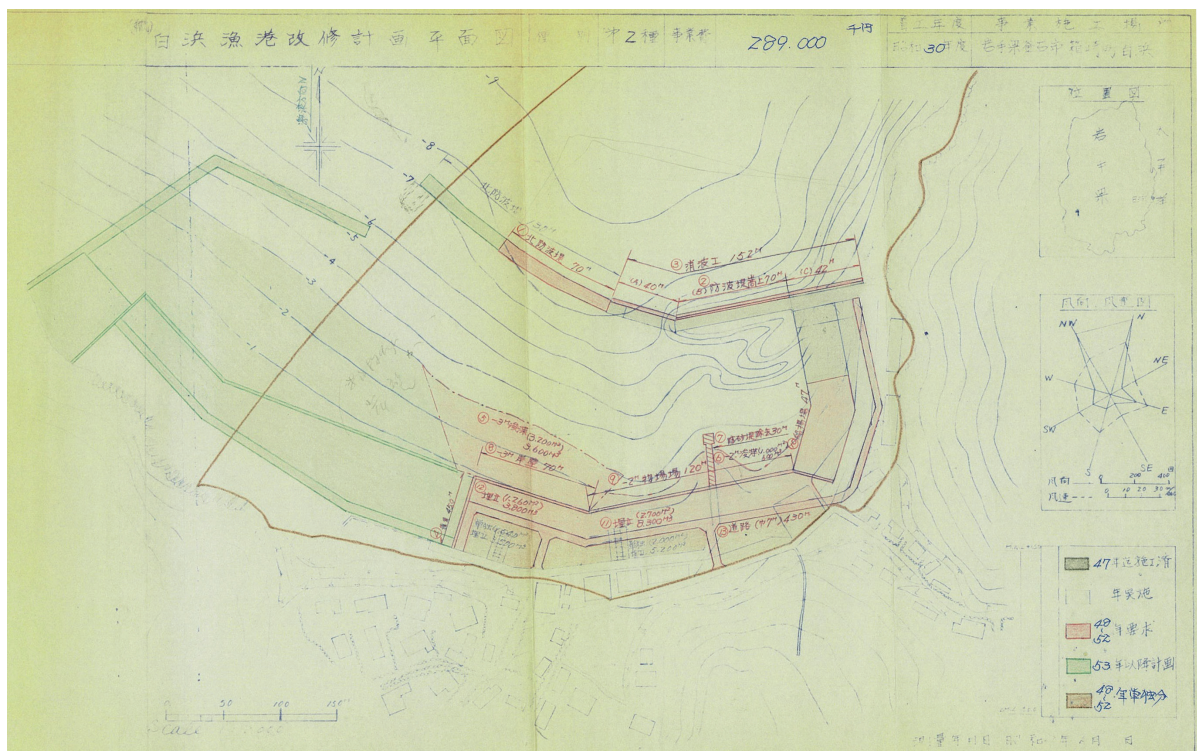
(鵜) 白浜漁港改修計画平面図 (第5次漁港整備計画)
